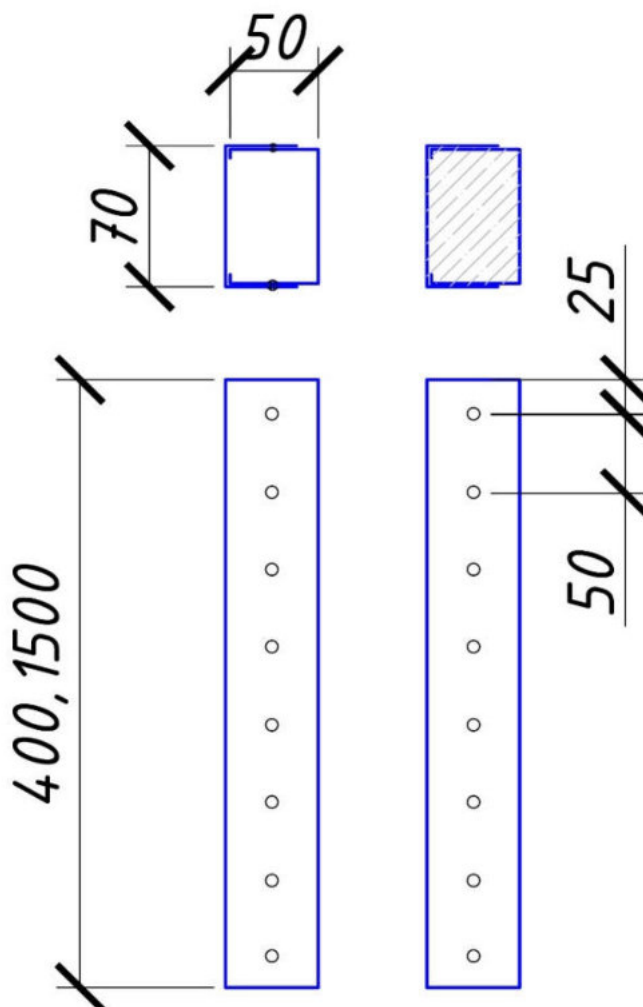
Схема виготовлення складеного перерізу сталезалізобетонної конструкції з легких бетонів
